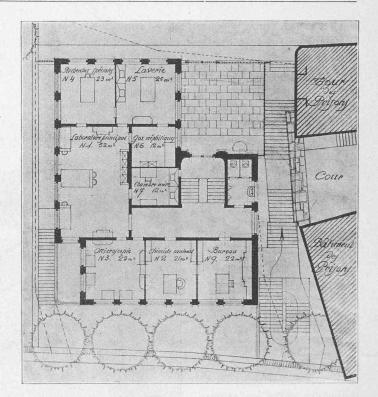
Plan du rez-de-chaussée. — 1:300.
